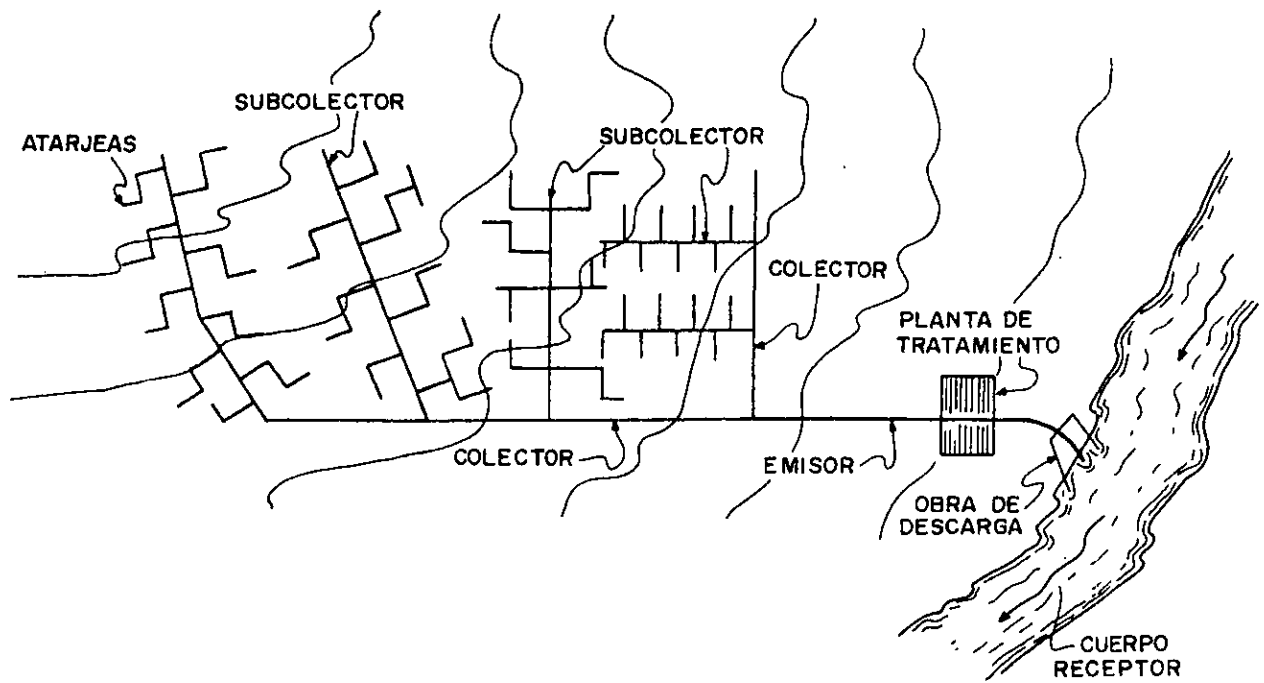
Conductos que forman la red de un sistema de alcantarillado.
